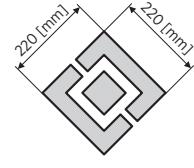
Tipo AP-6, dimensioni 220x220 [mm].
